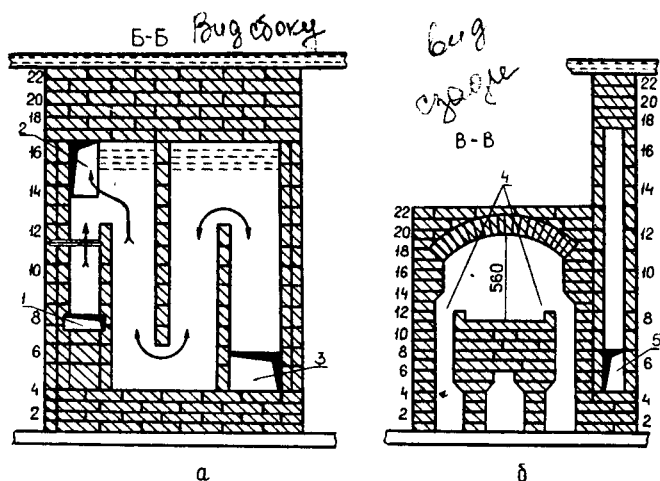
Отопительно-варочно-пекарская печь № 2: а — разрез по линии Б—Б; б — разрез по линии В—В; 1 — канал из-под варочной плиты; 2 — канал вывода газов из-под плиты и из обогревательного щитка в дымовую трубу; 3 — канал из тепловой камеры в обогревательный щиток; 4 — шпурь для пропуска горячих газов в тепловую камеру; 5 — подверток обогревательного щитка
